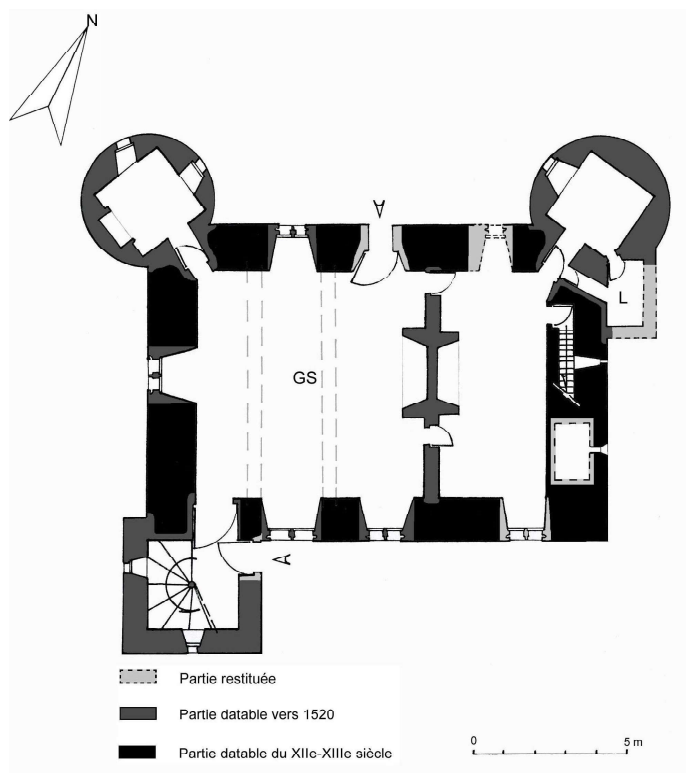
Prey. Plan restitué du rez-de-chaussée vers 1520.
